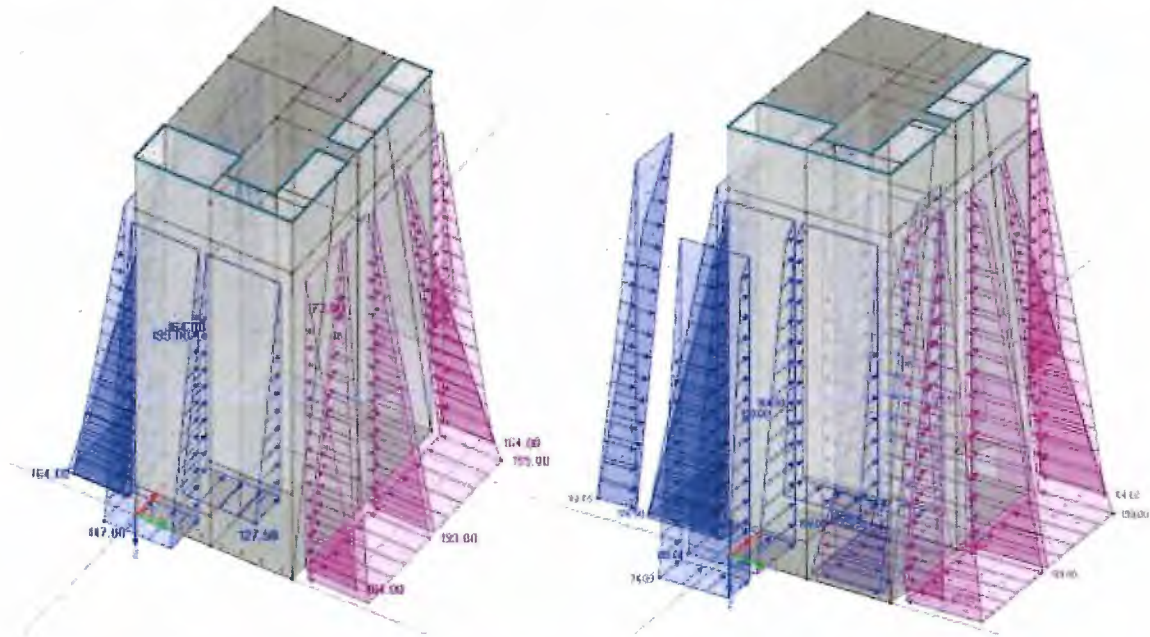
Einwirkungen auf Kontrollschacht: links EK1, rechts EK2; aus Vorstatik und Ergänzung
